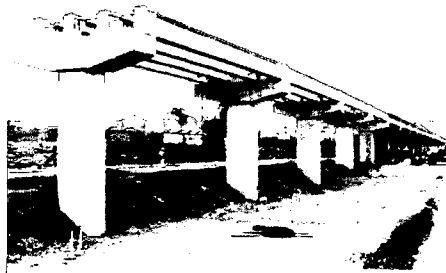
Vigas montados en las vigas cabezales prefabricados.
